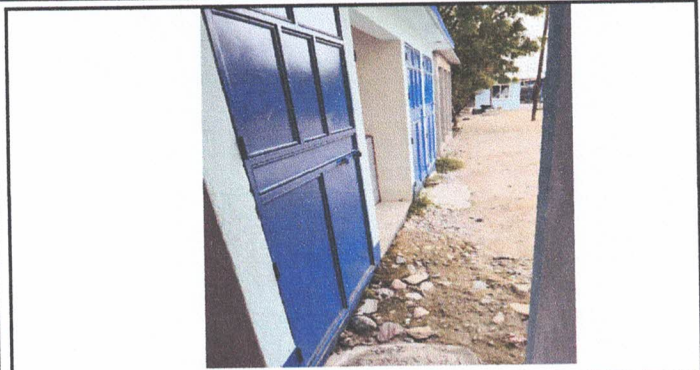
SUSTITUCIÓN O INSTALACIÓN DE PLANCHA DE CONCRETO EN BAÑOS
